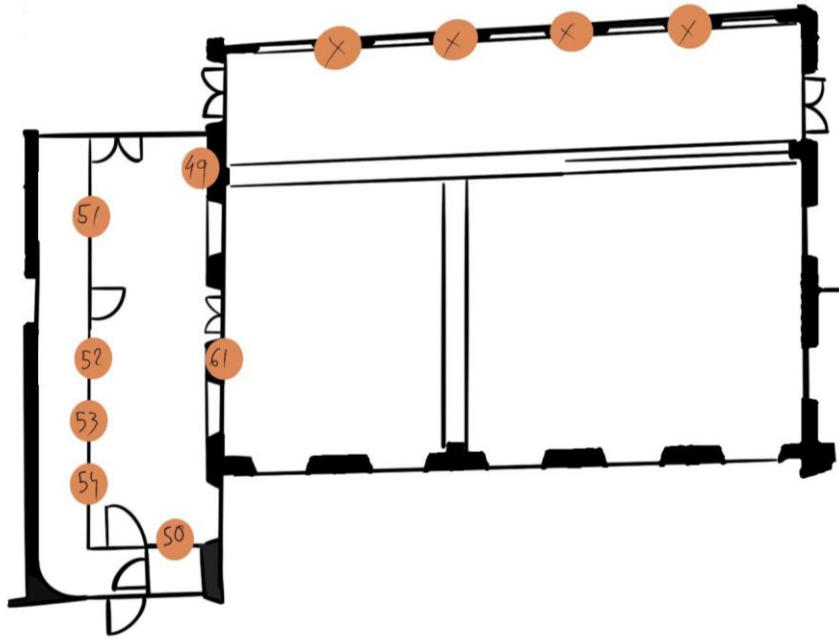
Plano de Galería Alta y Sala Zurbarán
